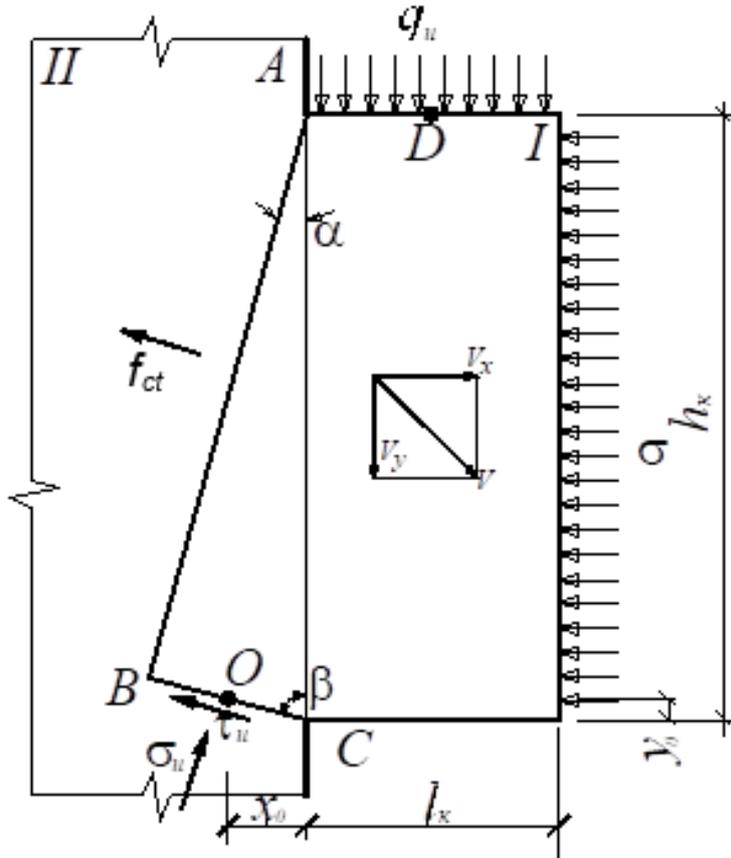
Кінематично можлива схема руйнування прямокутних бетонних обтиснутих шпонок при зрізі
